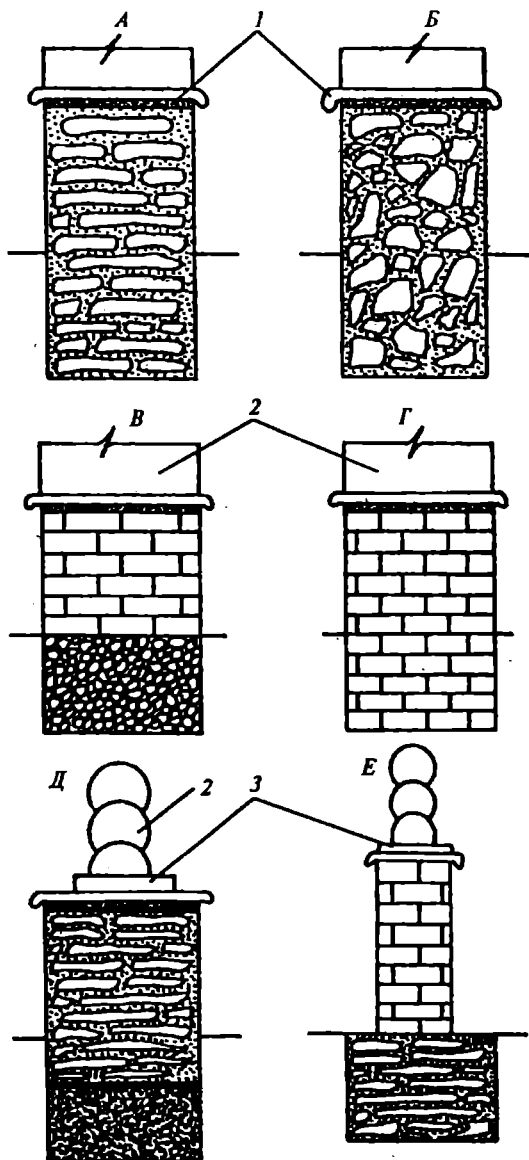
Устройство ленточных фундаментов из разных материалов: А — бутовый; Б — бутобетонный; В — кирпичный по бутобетону; Г — кирпичный; Д — бутовый по песчаной подушке; Е — кирпичный по буту; 1 — гидроизоляция; 2 — стены; 3 — подкладки
